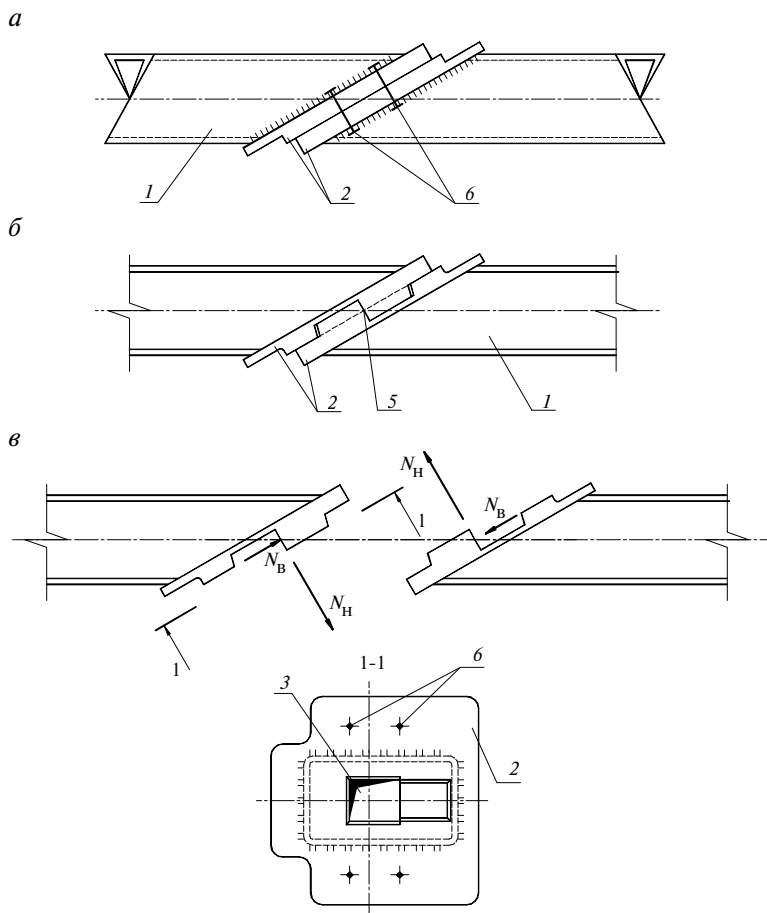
Стык нижнего пояса стропильной фермы с фланцами из стального литья: *а* – вид сверху; *б* – сечение по оси стыка; *в* – разомкнутый стык и расчетная схема стыка: 1 – соединяемые элементы; 2 – фланец; 3 – углубление для размещения упора смежного фланца; 5 – центр стыка; 6 – стяжной болт
